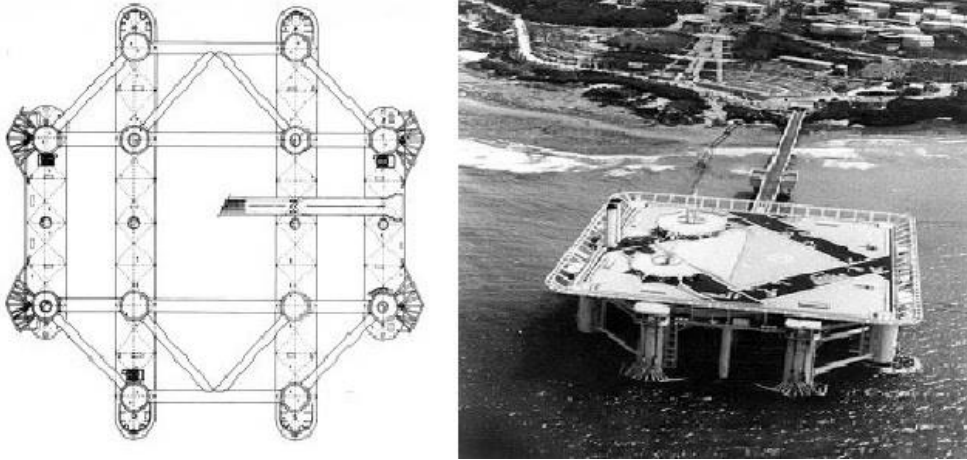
Plano de sección horizontal e imagen desde el aire de 'Aquapolis', 1975, K. Kikutake.
